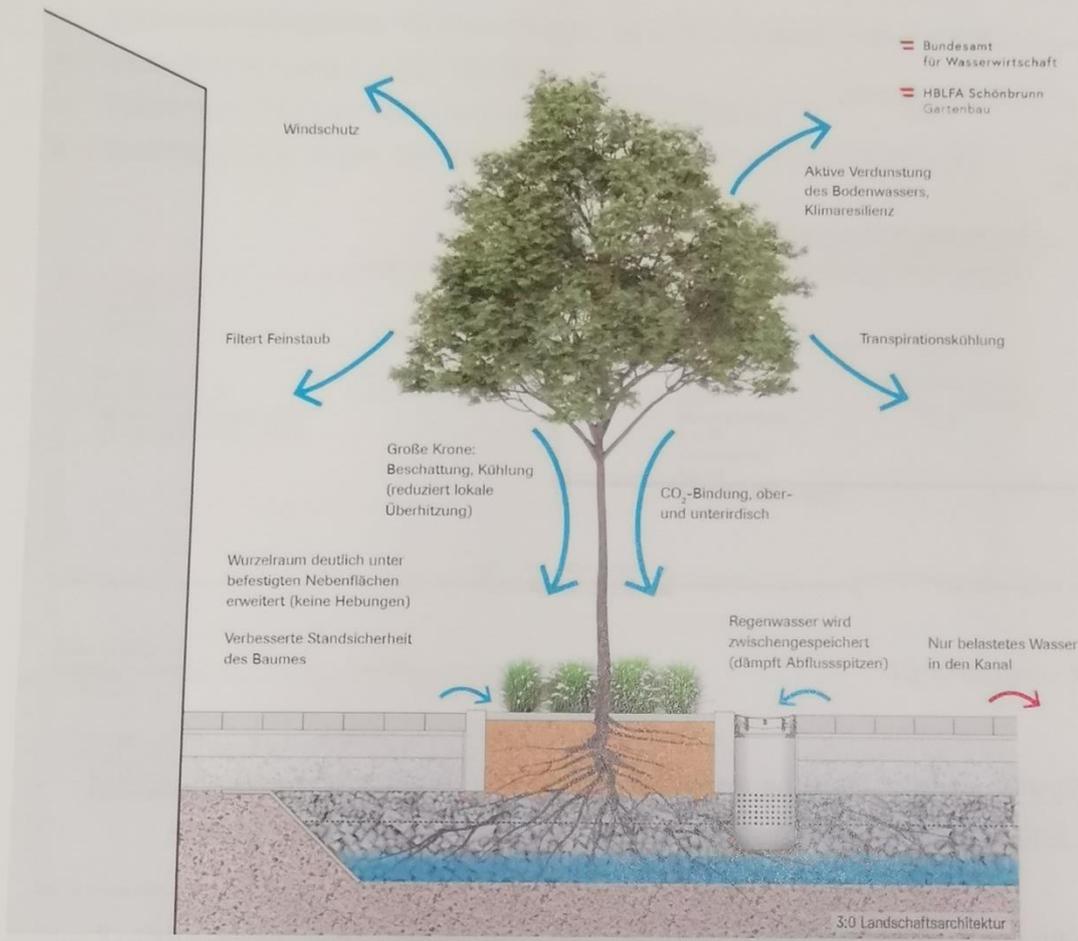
Schemaskizze eines Baumstandortes nach dem Schwammstadt Prinzip
